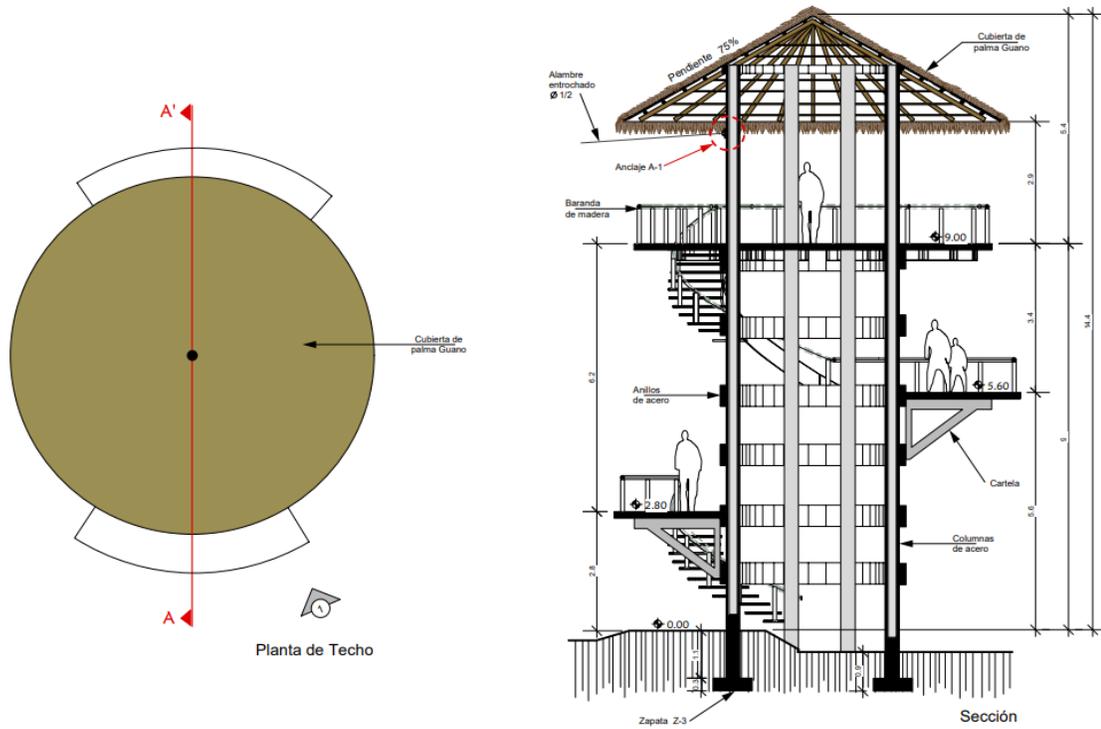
Planta de techo y sección de canopy. Fuente: sitio web
